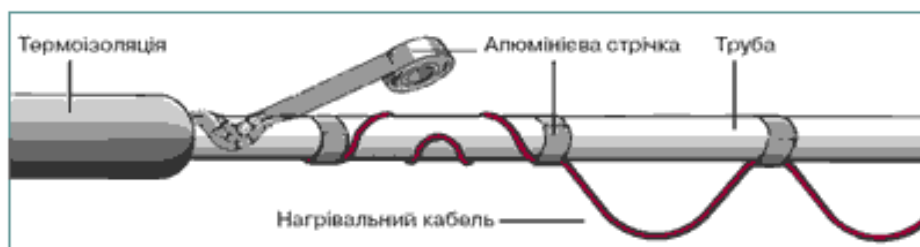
Монтаж нагрівального кабелю на трубу
